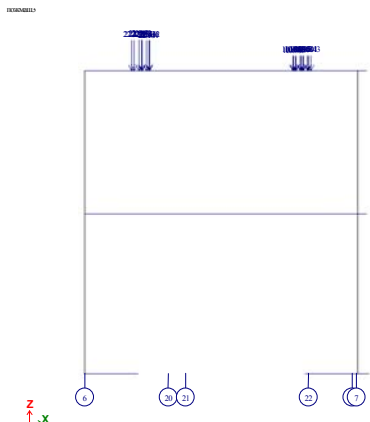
Схемы загрузки покрытия автостоянки нагрузкой-штамп от пожарных машин (фрагмент)
